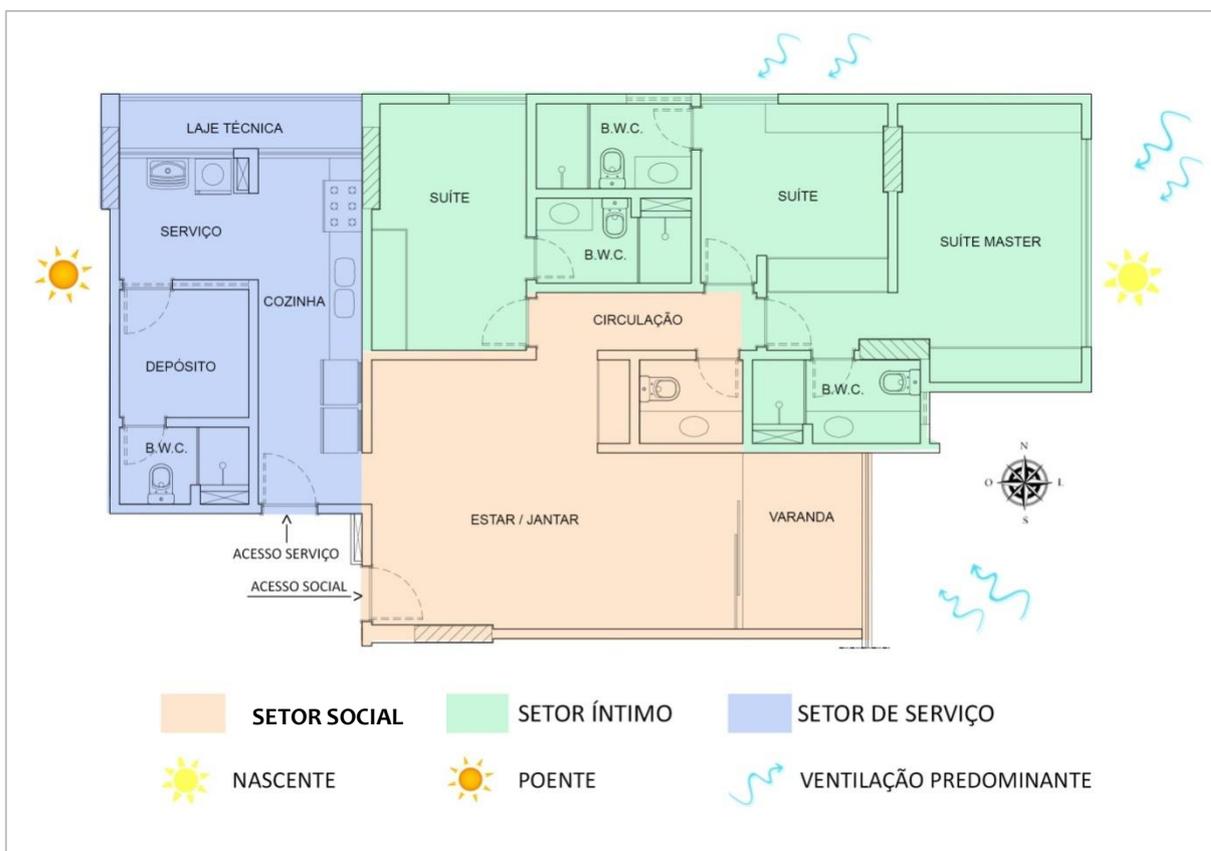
Planta baixa do apartamento tipo das terminações 01 e 02 do edifício Marine Park
